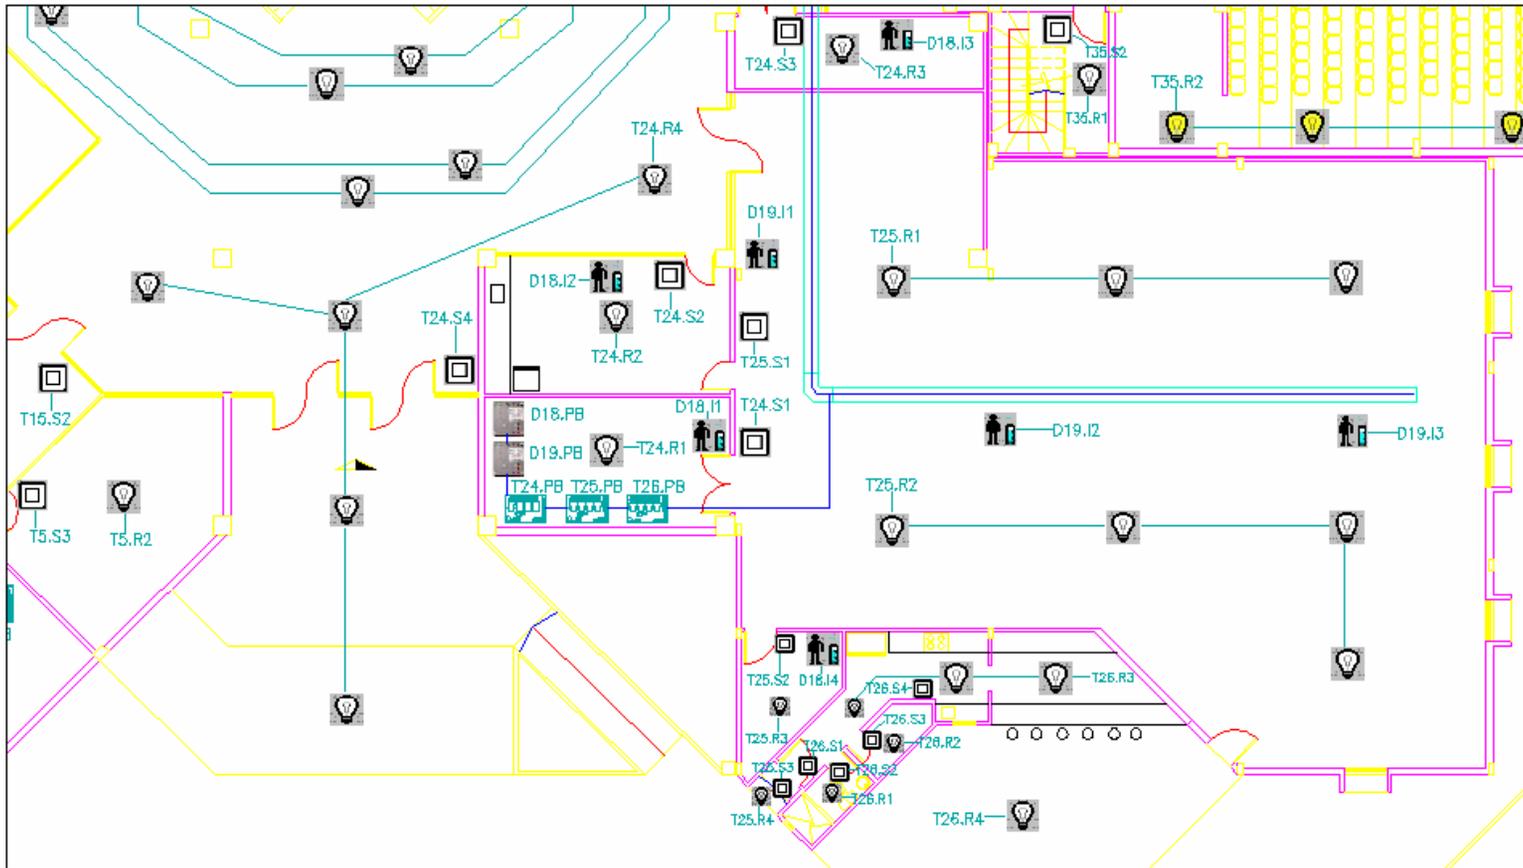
PLANO ILUMINACION PLANTA BAJA SECCION 2
